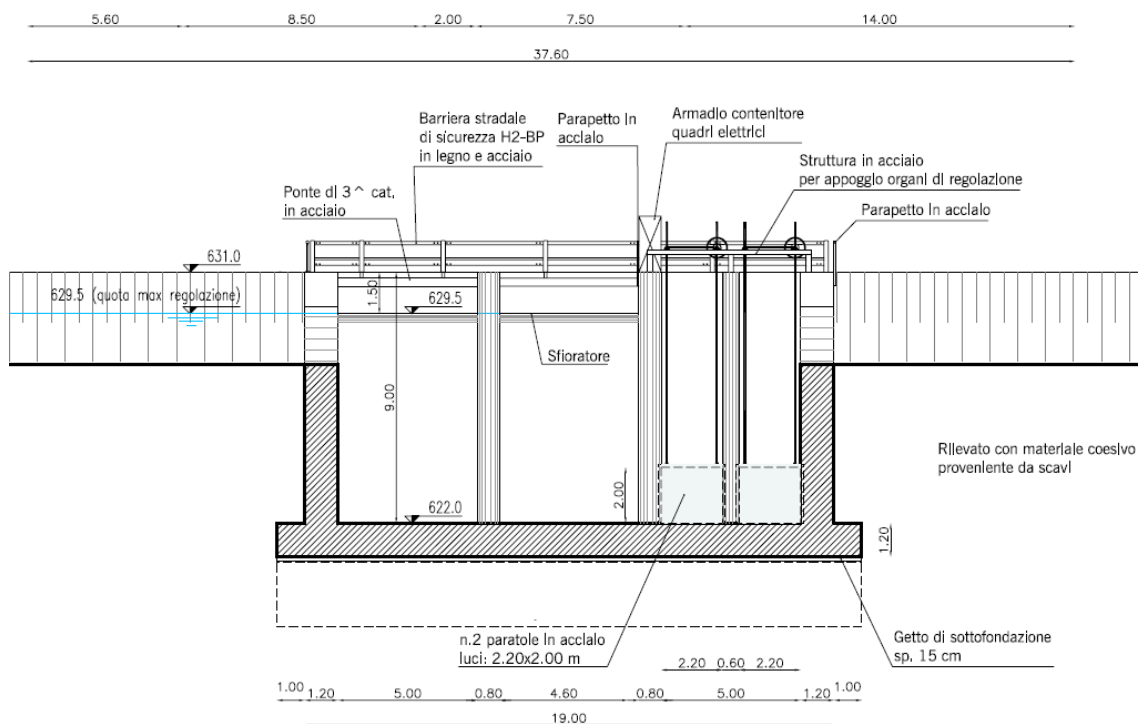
Sezione trasversale della traversa di regolazione. Cassa sul T. Vallemura.
